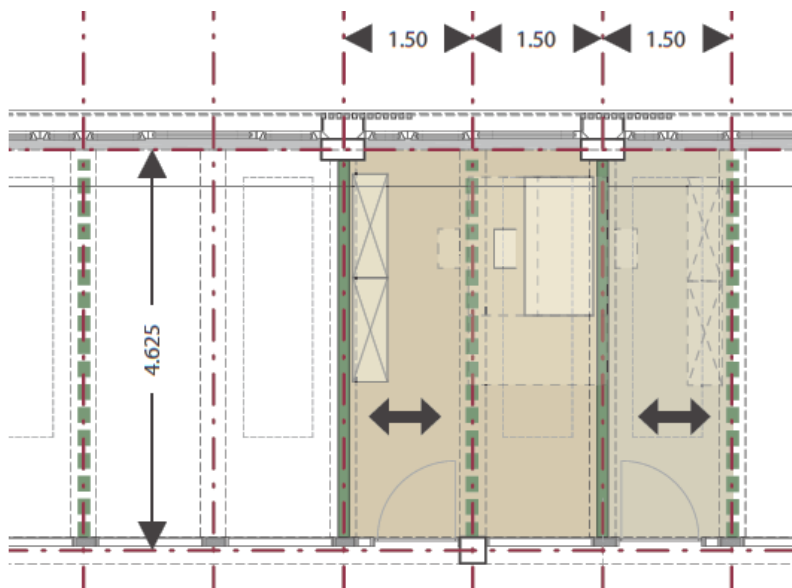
Grundrissausschnitt Büro - Ausbauraster
